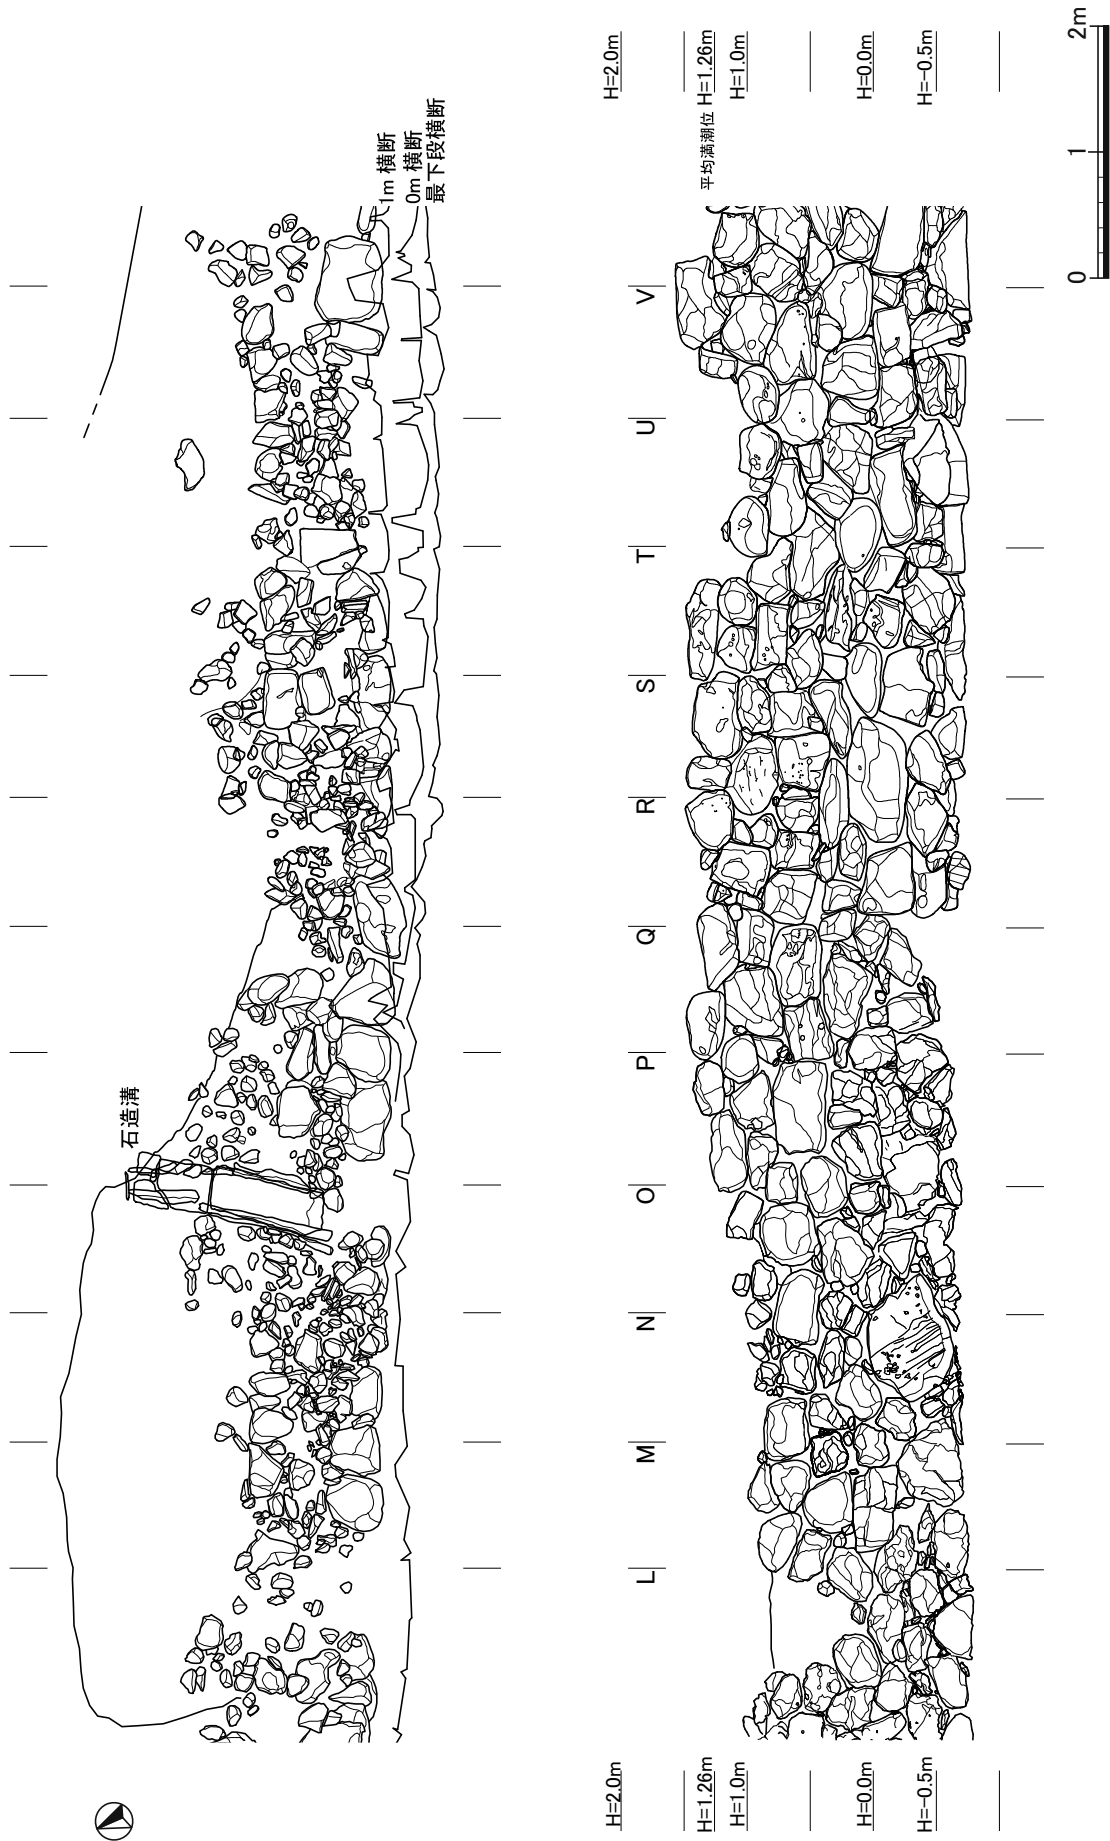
①-2 南側護岸石垣 平面図・立面図 (S=1/60)
